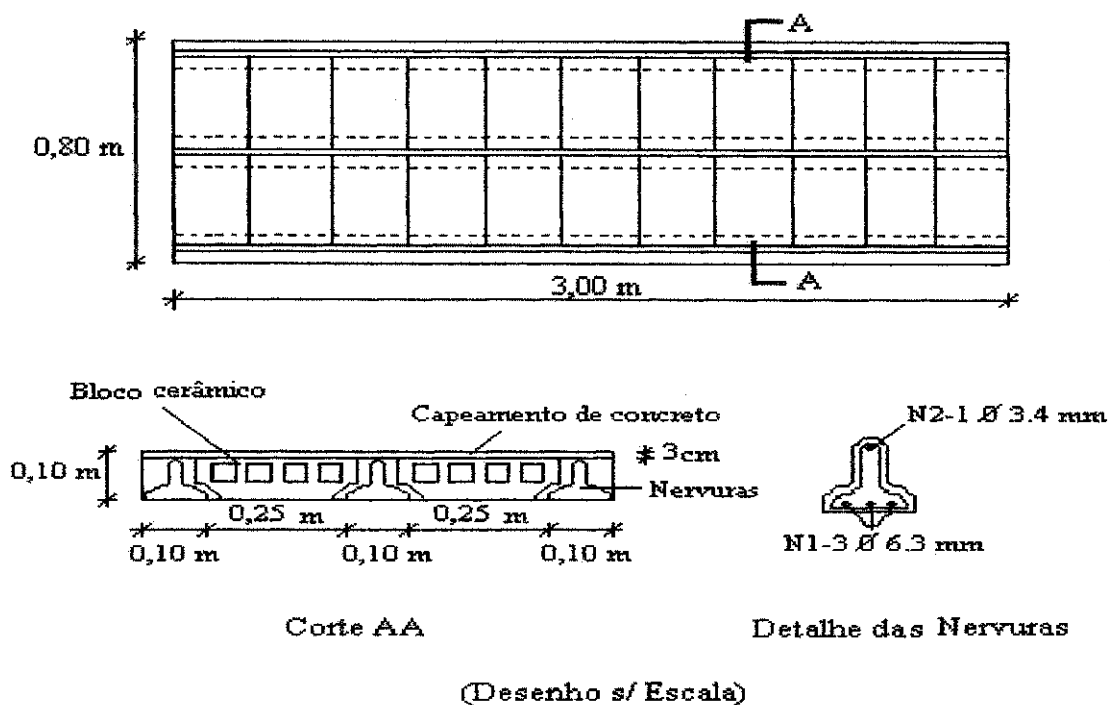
Detalhe das Lajes Pré-Moldadas
